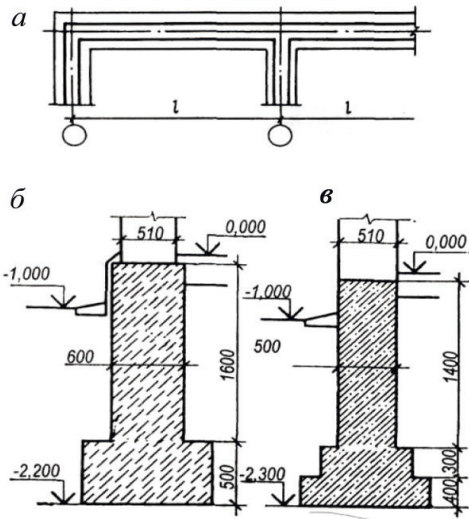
Стрічкові монолітні фундаменти під цегляну стіну:
